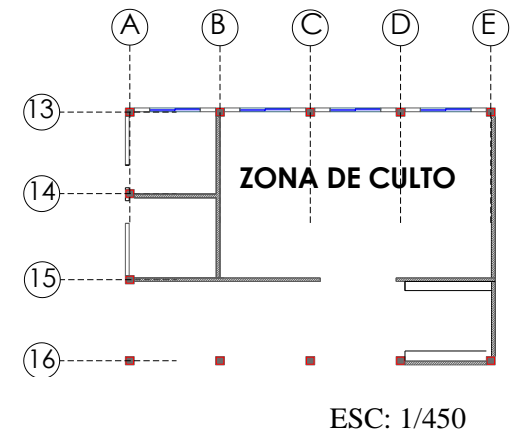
Planta Subterránea 1. Ex Academia Militar Juan Gómez Rendón
